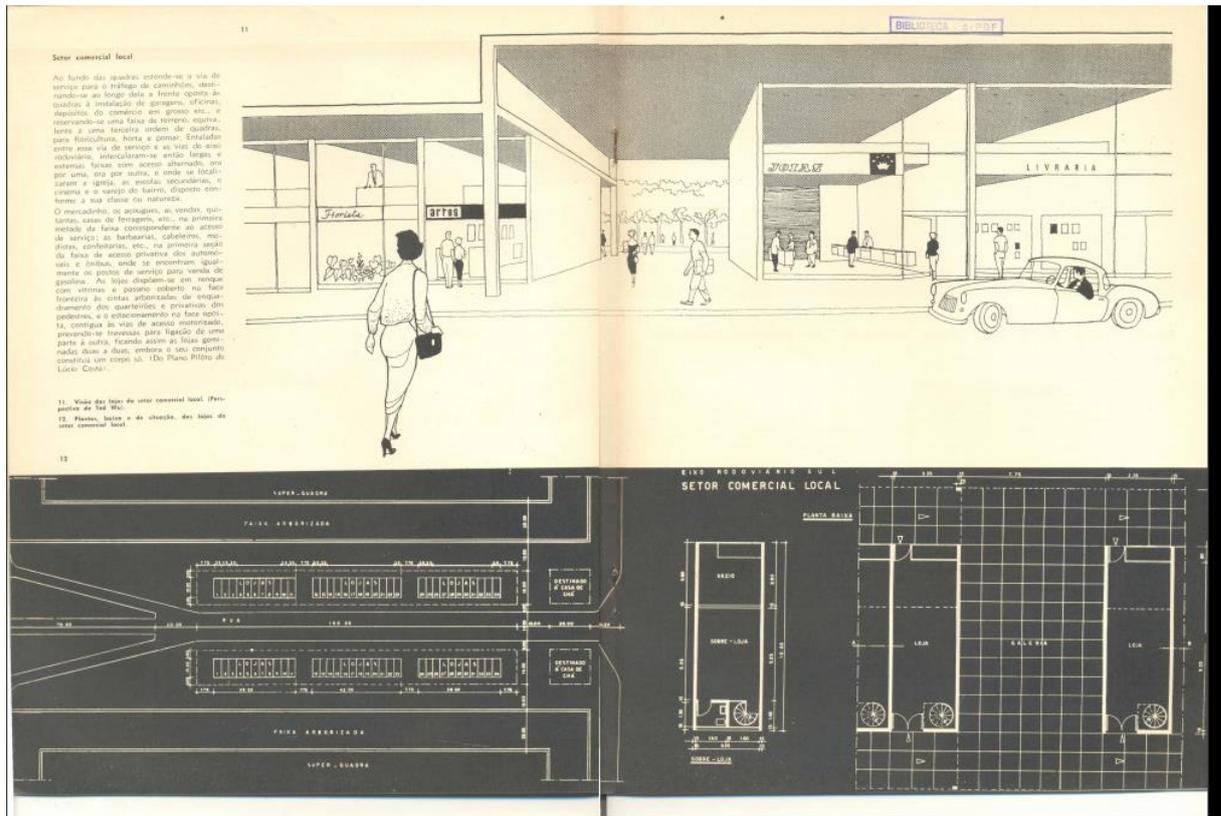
Croqui publicado na Revista Brasília, nº 9, de 1957.
